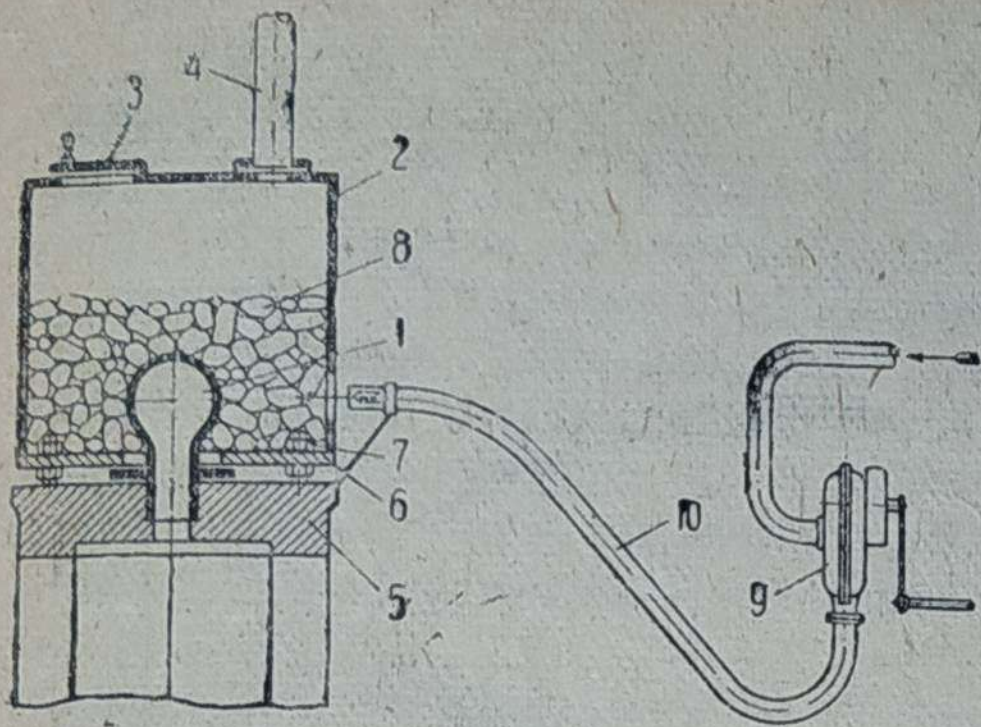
Схема угольной грелки при розжиге вентилятором:
